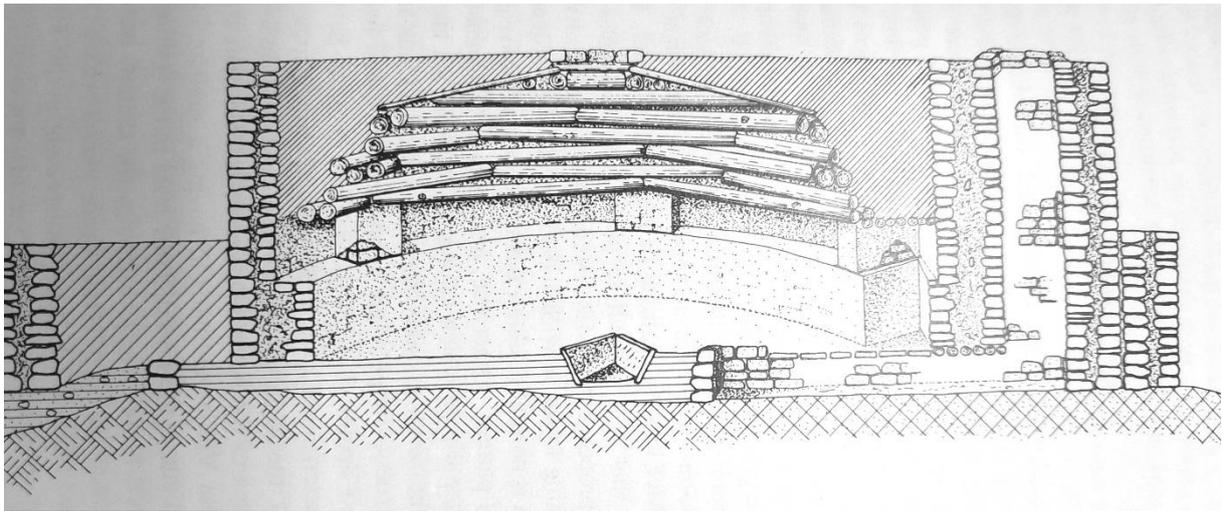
Plan en coupe d'une kiva à Mesa Verde (dans LISER, 1967, p. 21)
